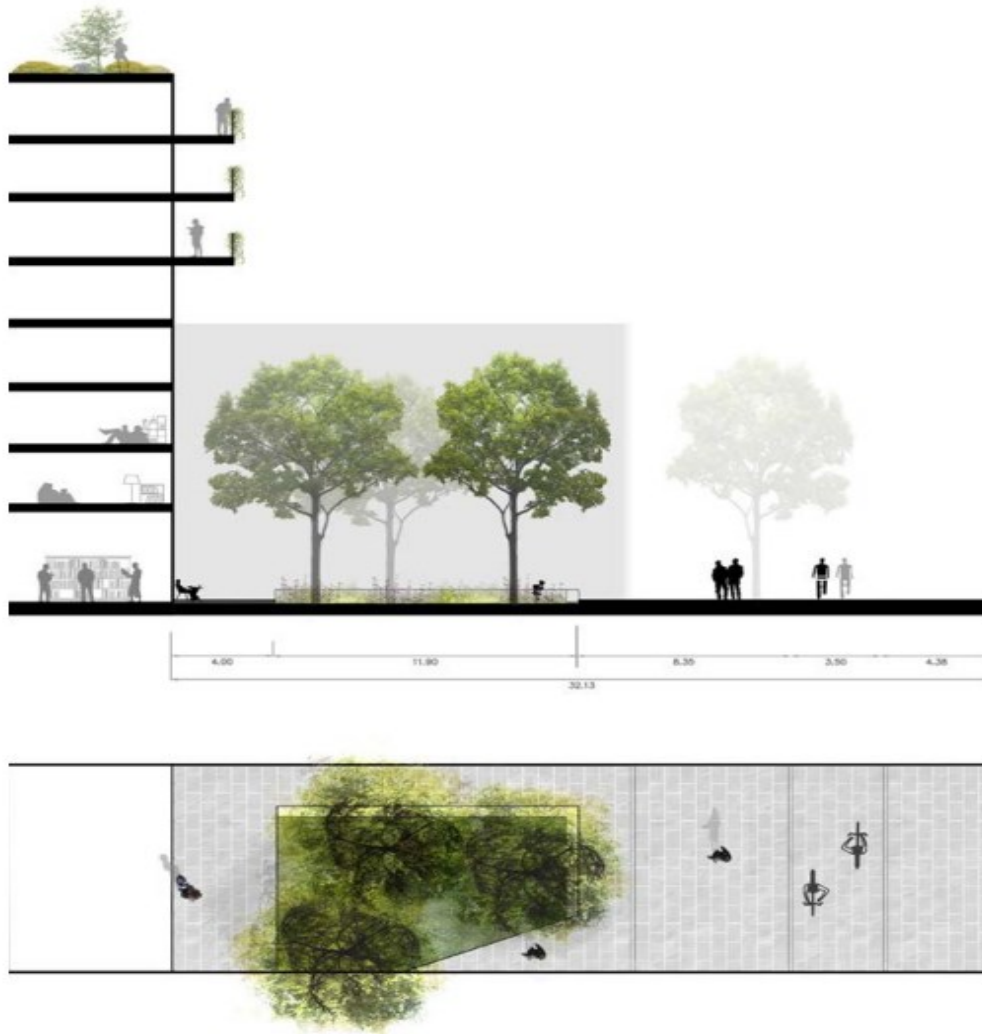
Representação esquemática de um bolso ajardinado – perfil e planta
